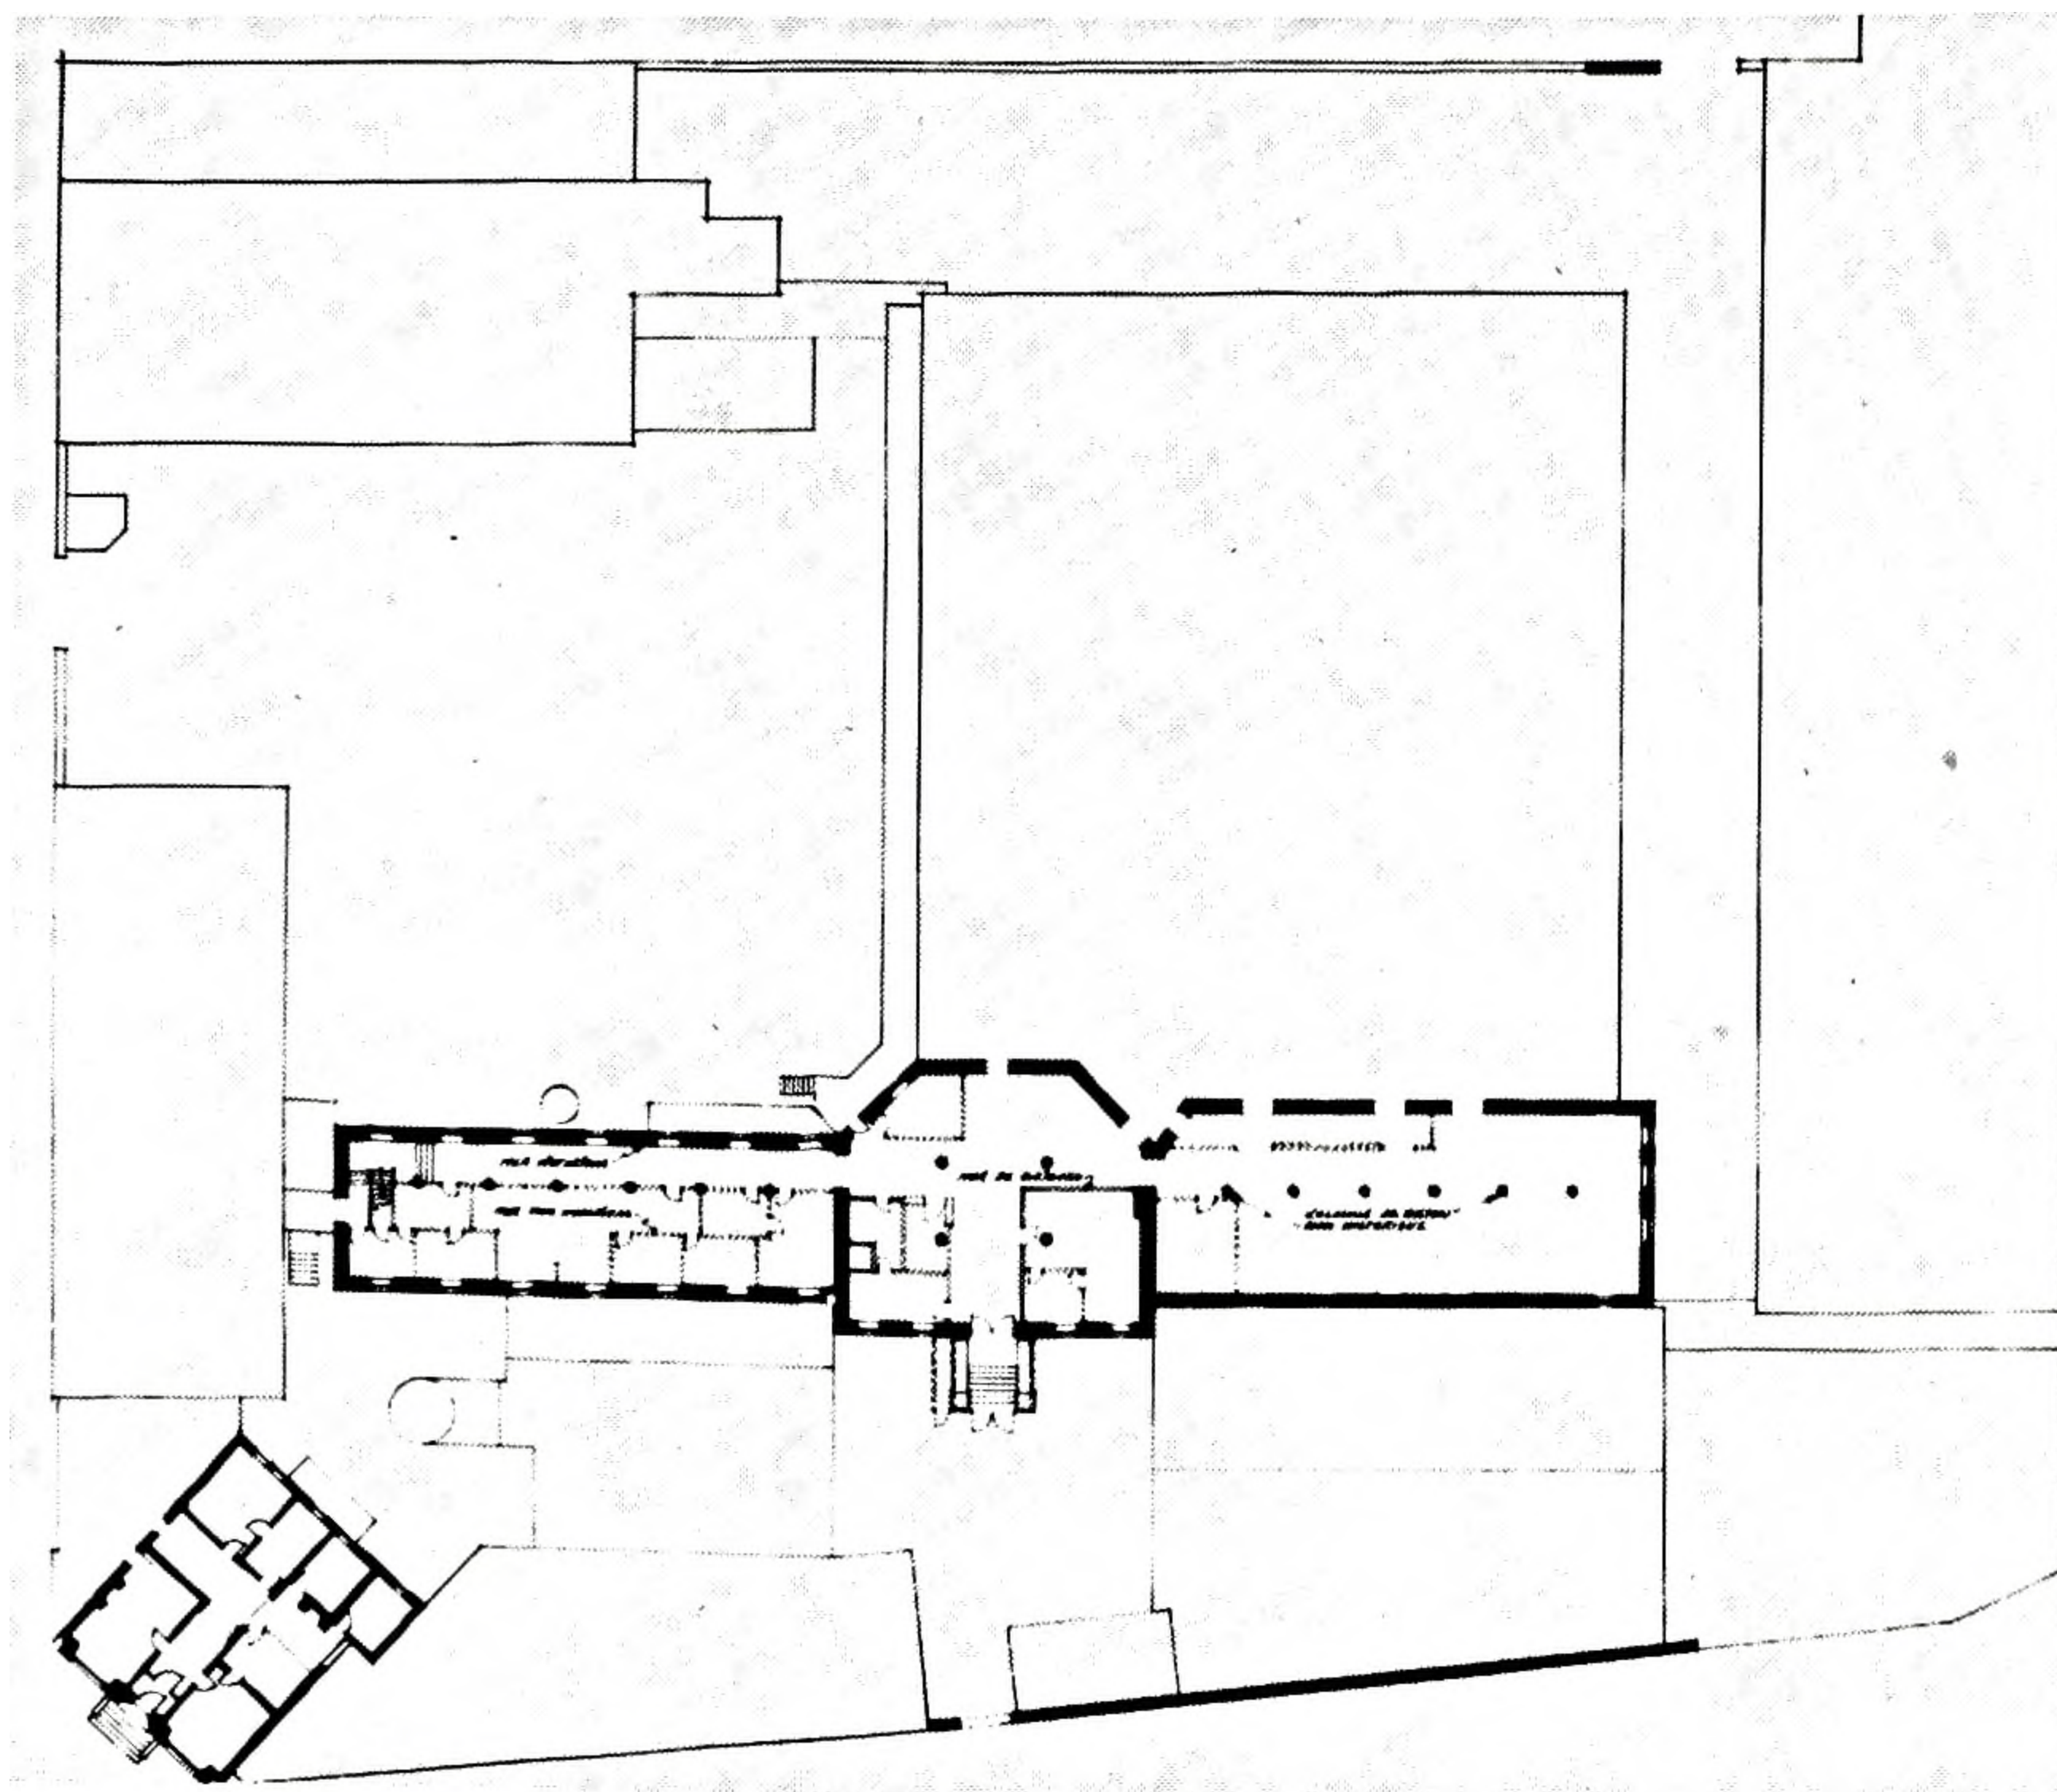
Plan du rez-de-chaussée de la prison, de la maison du gouverneur, du portail et d'une section du mur d'enceinte, (dessin de Pierre d'Anjou et Georges Leonidoff).
